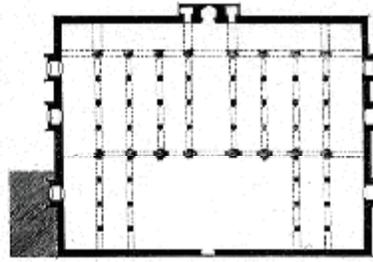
مسقط أفقي لجامع حسان بالرباط
